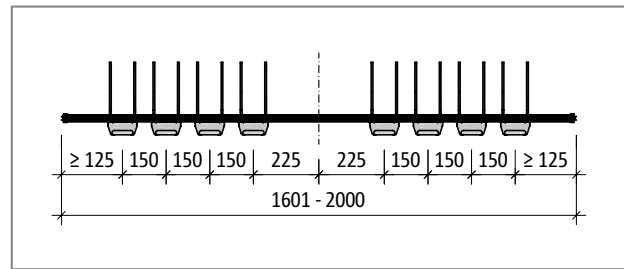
Schöck Tronsole® Typ T-V8-H...-L1601 bis L2000: Produktgrundriss
